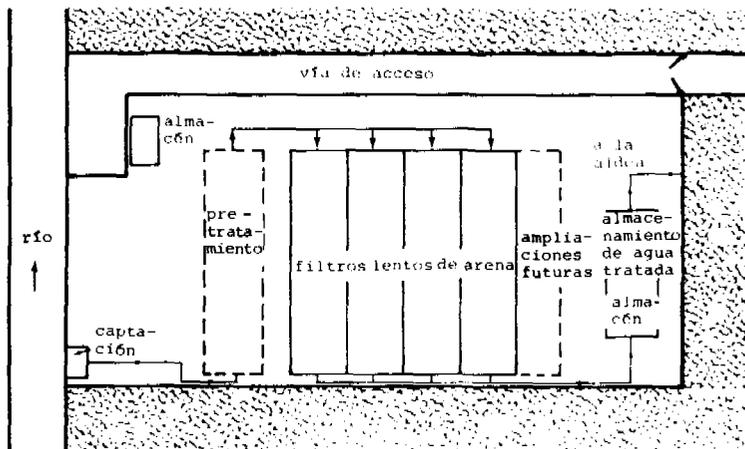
Esquema de planta de tratamiento que comprende el diseño típico No. IV.
